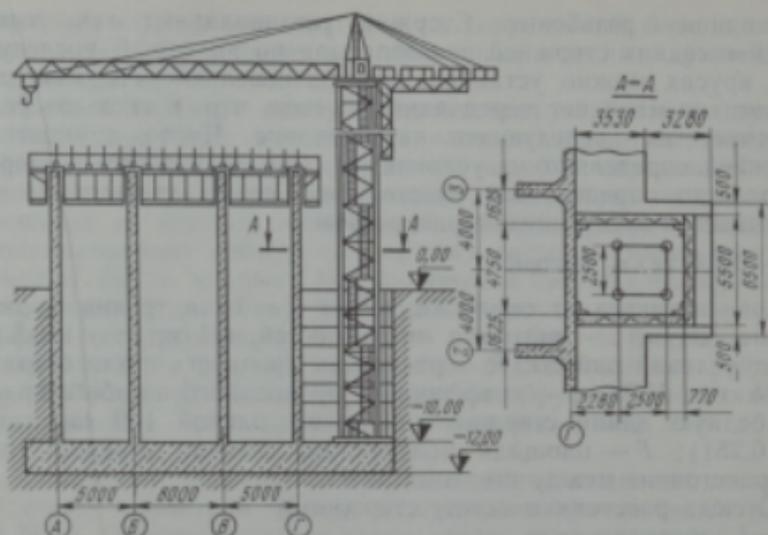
Бетонирование стен башенного копра с применением приставного крана
